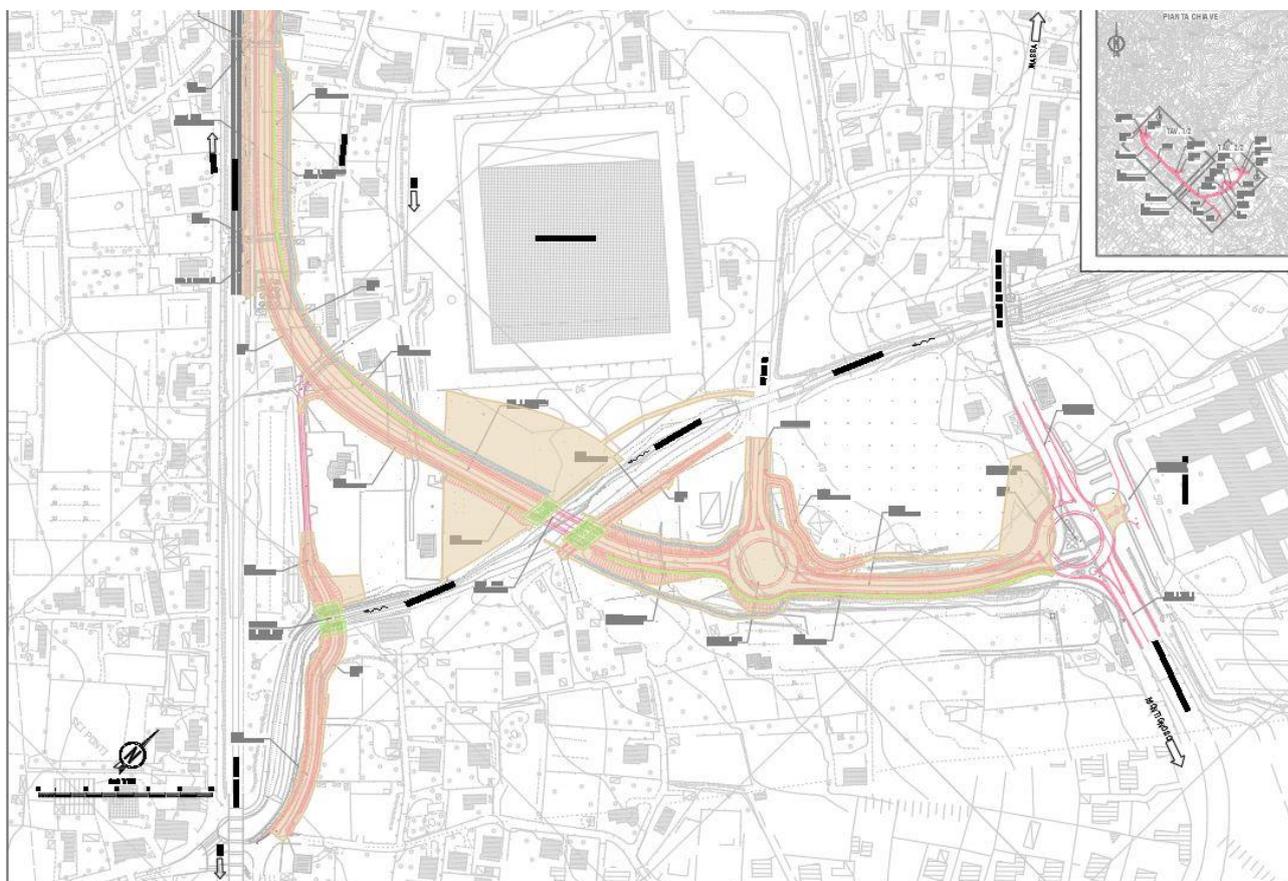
Estratto planimetria aree di bonifica - da rotonda R.04
